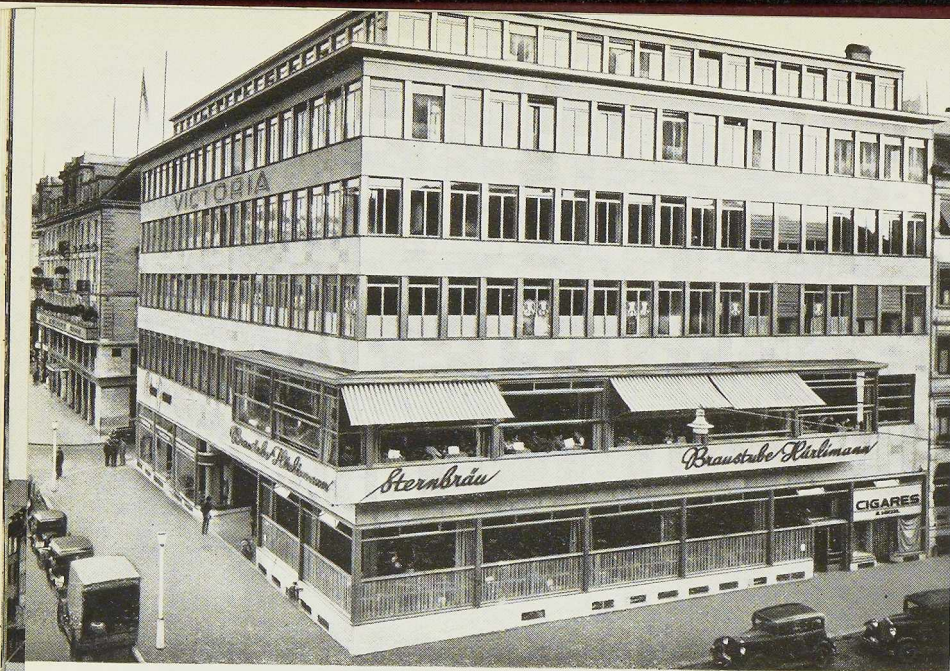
Le bâtiment Victoria à Zurich. Surface bâtie : 950 mètres carrés. Poids de l'ossature métallique : 430 tonnes, soit 20 kg par mètre cube de bâtiment. Année de construction : 1933-1934. Les façades sont formées de bandes horizontales revêtues de pierres de taille alternant avec les bandes horizontales des fenêtres, dans lesquelles d'étroits trumeaux revêtus d'une tôle en anticorrosion dissimulent les poteaux de l'ossature. Les fenêtres à châssis métalliques sont à double vitrage.
